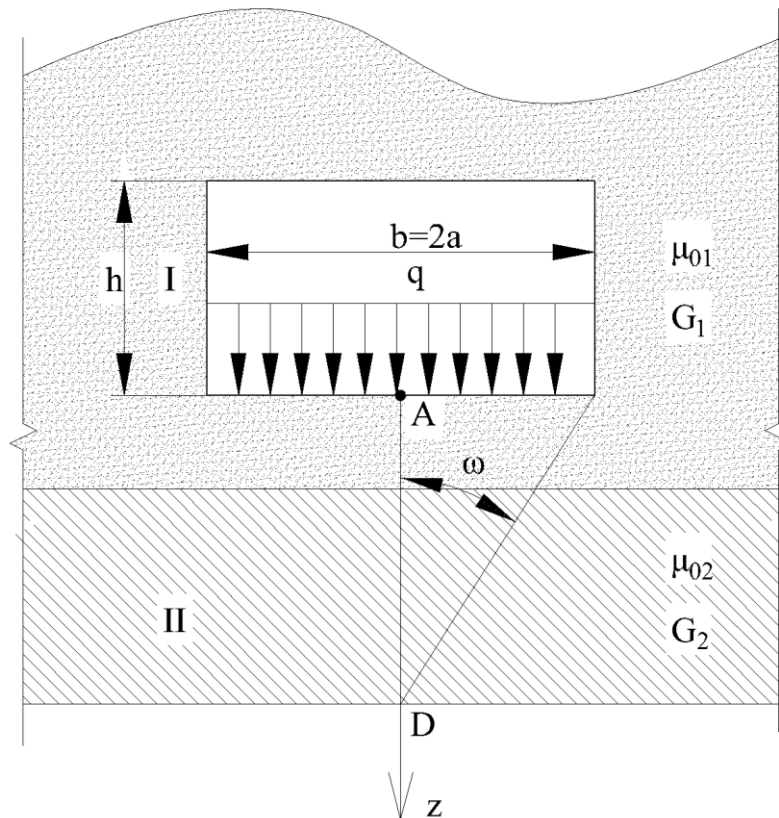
Двухслойное основание с нагрузкой q от сооружения и вышележащих грунтов
